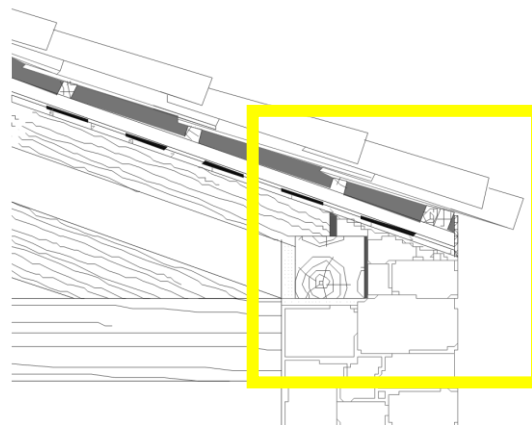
Detalle de la colocación de las sobrecarreras y los cabios.
